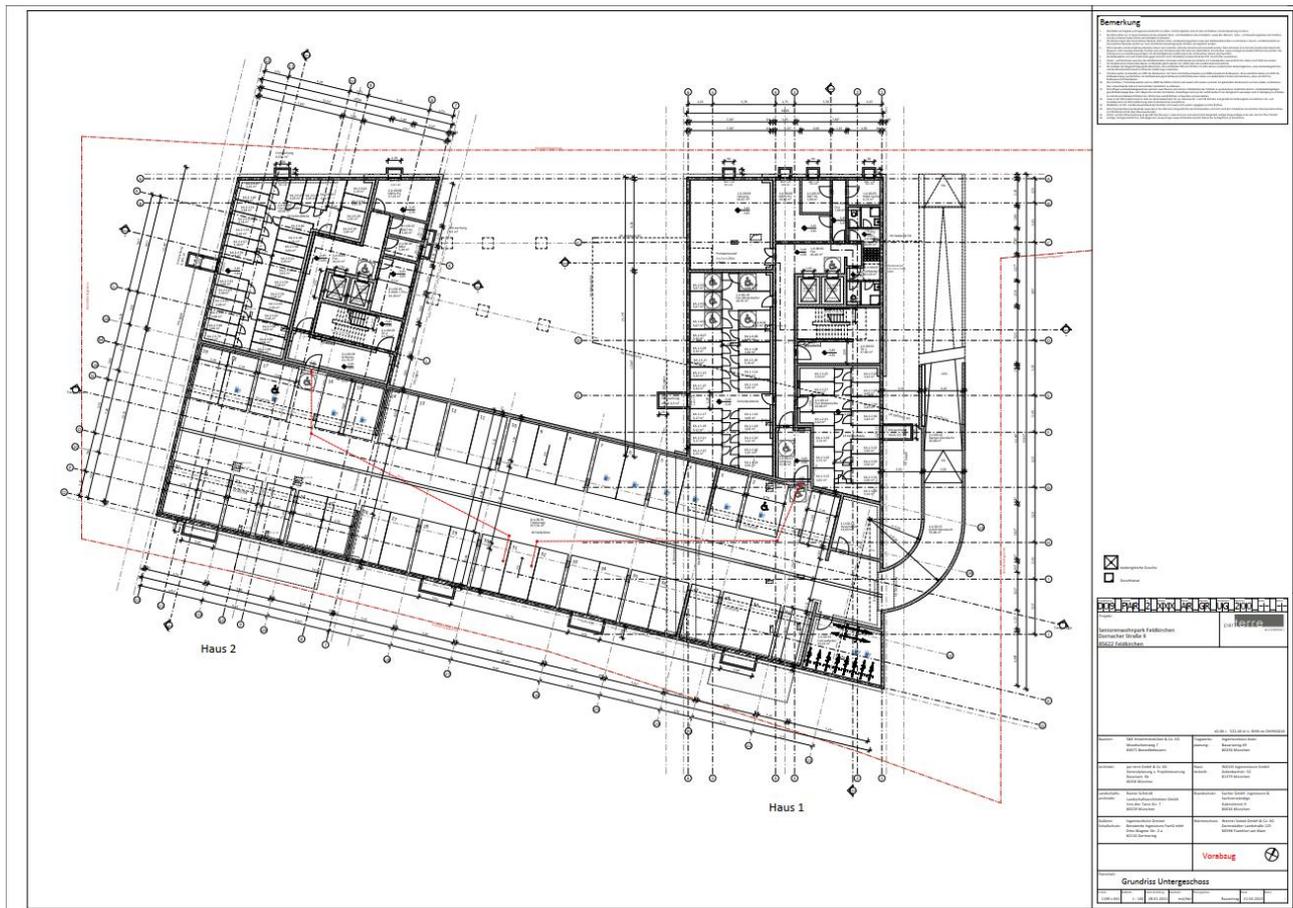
Grundriss Untergeschoss - Seniorenwohnpark Feldkirchen [par terre architekten, Stand: 21.04.2022]
